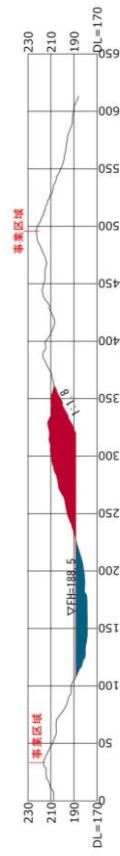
(3) 切土・盛土計画断面図 (E3-E3' 断面)
